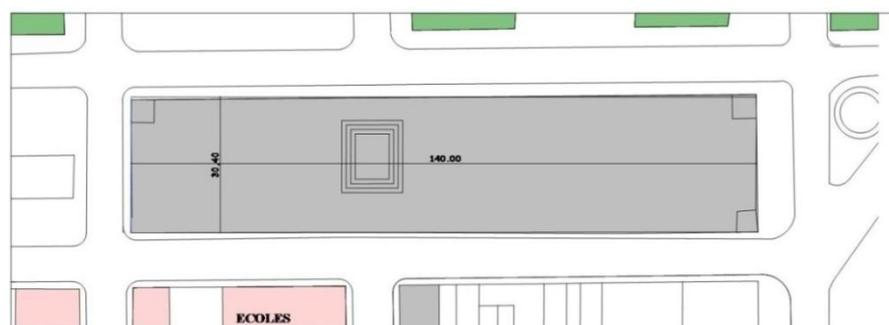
rapport entre la longueur et la largeur du plan, place Ben Boulaid.
